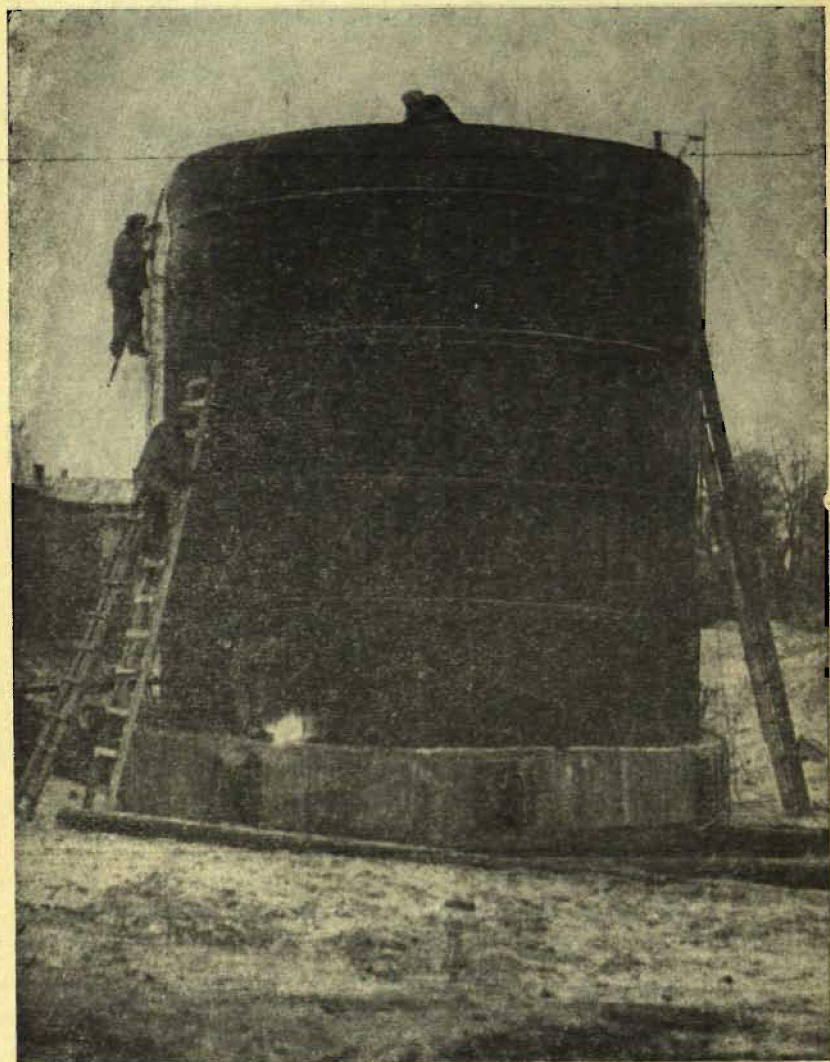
Строительство часового подвала. Сварка металлического цилиндра в 1958 г.
